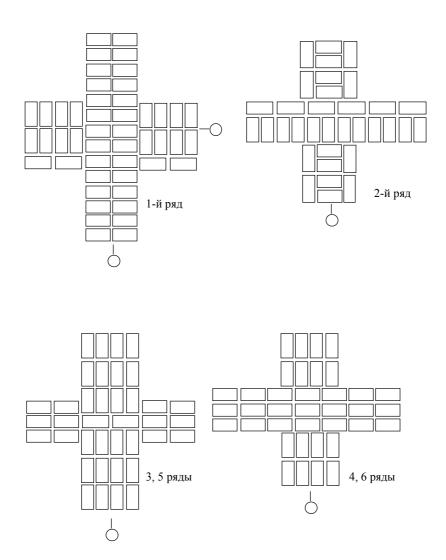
Кладка пересечений стен толщиной в 2 и 1,5 кирпича
